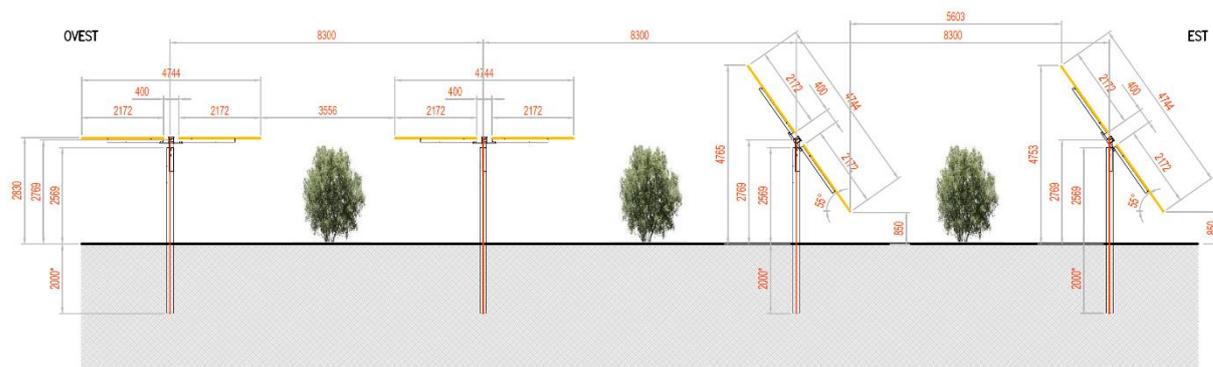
Tipologico – Vista Planimetrica dell'impianto Olivicolo
